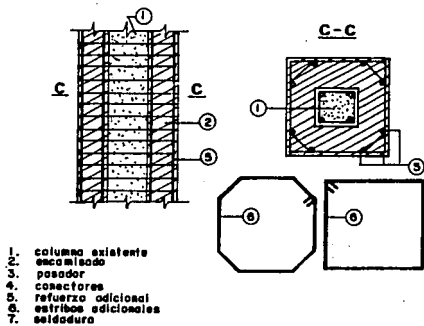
Encamisado completo de columnas (Ref. 15)
